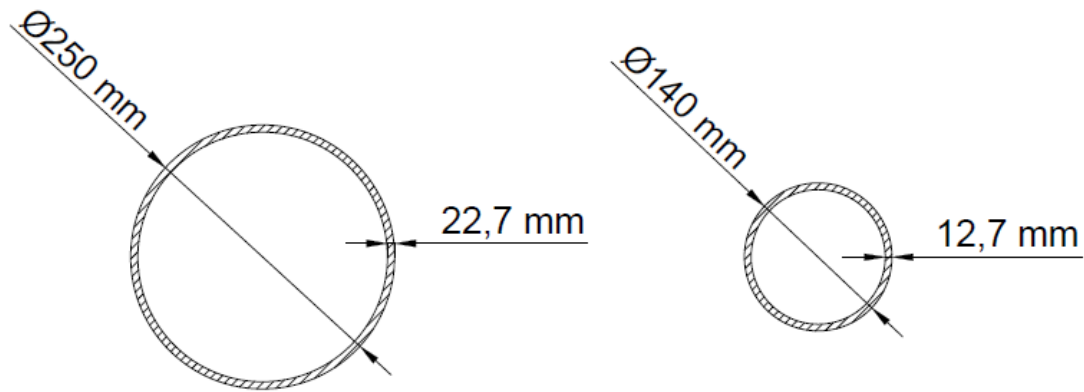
Dimensions de les seccions de les canonades d'aspiració (dreta) i impulsó (esquerra). Font: Pròpia.
